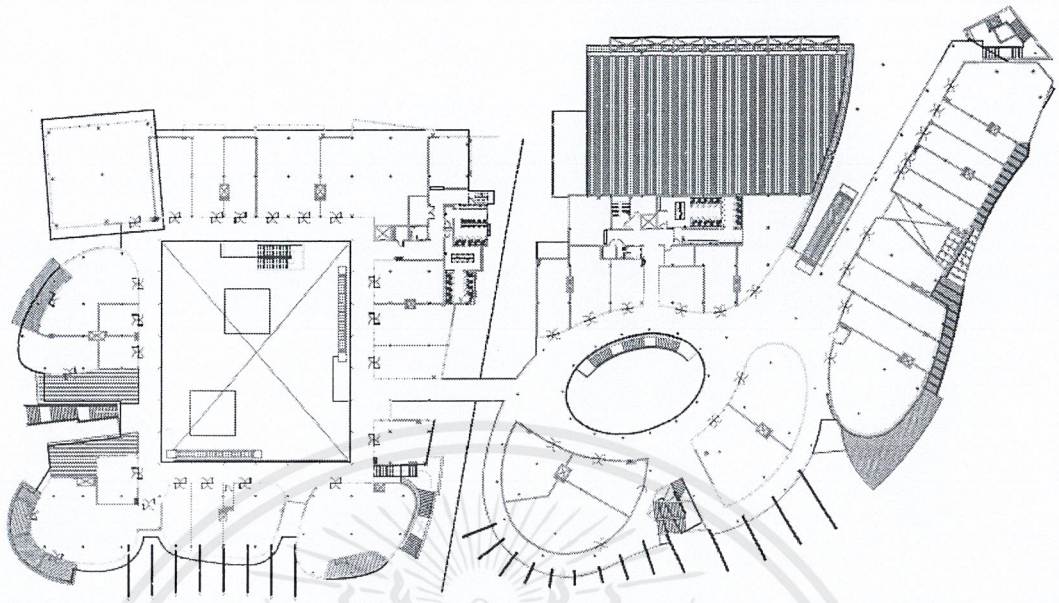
แสดง layout ของโครงการ K-Village
